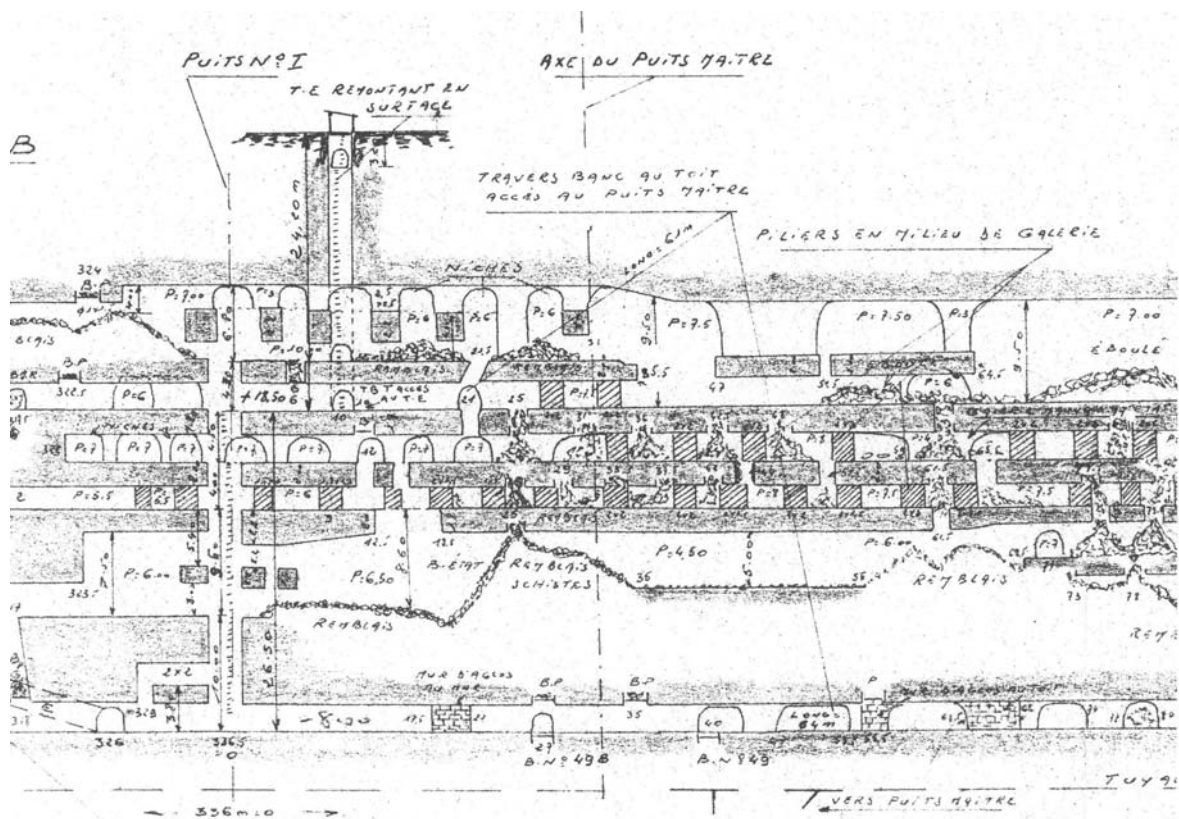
Travaux du flanc nord près du puits Saint-André (coupe longitudinale dans le plan de la couche)
